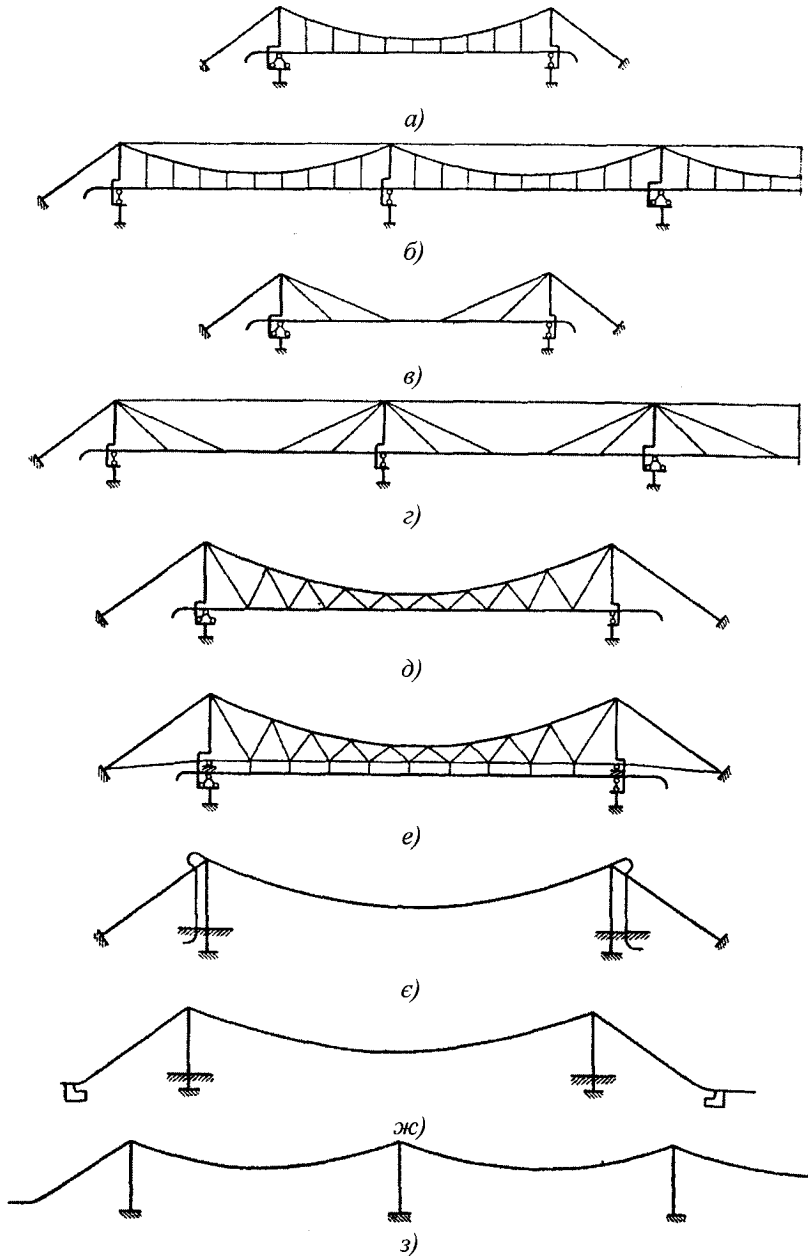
Схеми висячих трубопровідних переходів: а, б – з одноланцюговими фермами; в, г – з радіально-вантовими фермами; д, е – з вантовими фермами з трикутною решіткою; є–з – у вигляді нитки, що провисає
